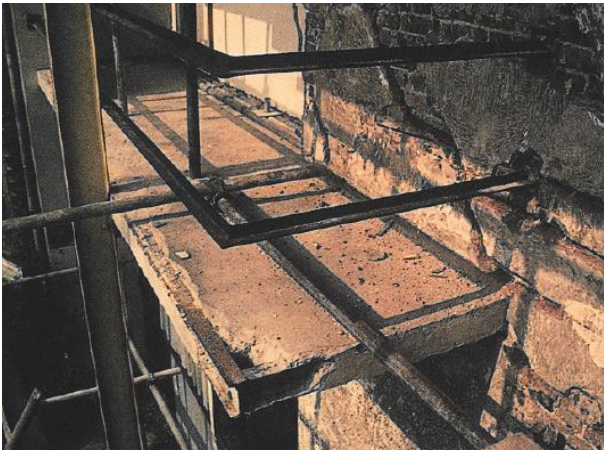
Balkon zuidgevel tijdens restauratie. Staalconstructie zichtbaar. (Zijl and Mulder 2009)
